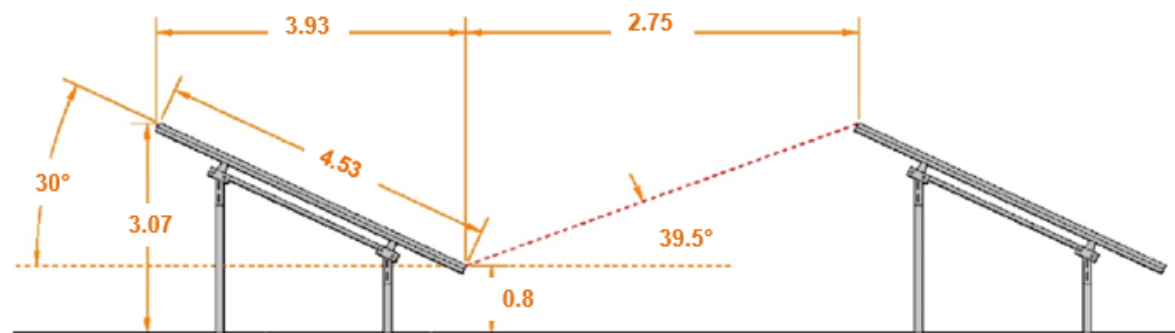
Plan en coupe des structures solaires – Source : Valeco
